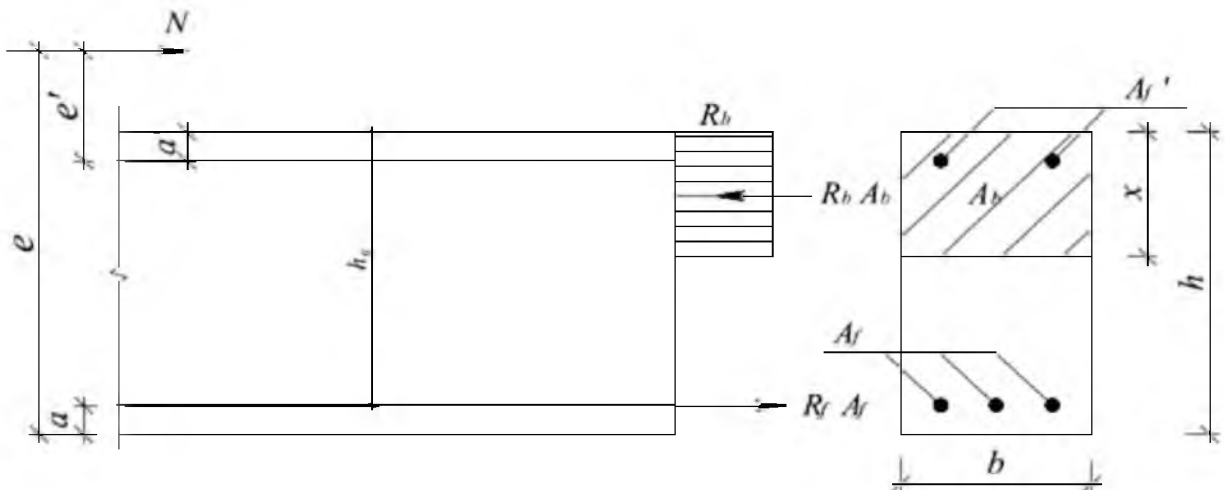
Схема усилий и эпюра напряжений в сечении, нормальном к продольной оси внецентренно сжатой конструкции, при расчете ее по прочности.
